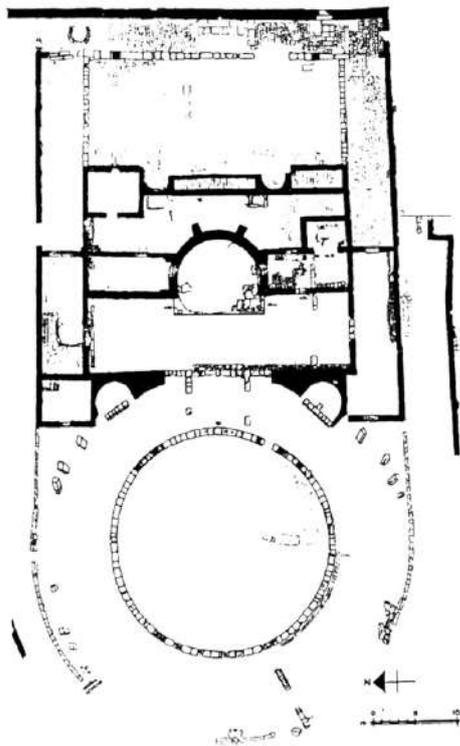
Rundkirchen von Beth Shean (Palästina)
